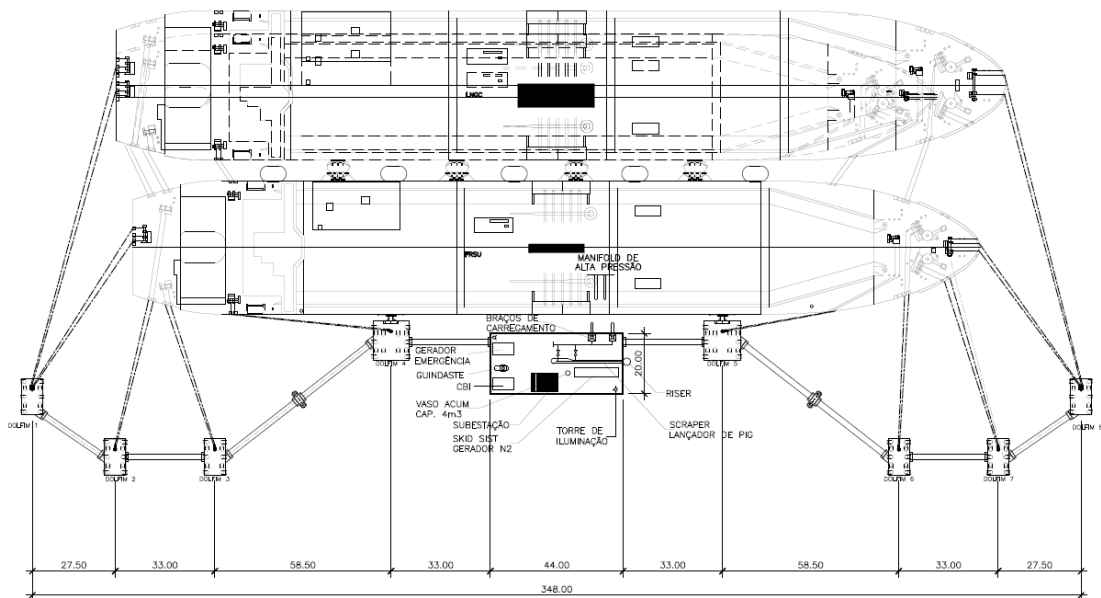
Planta do Pier de atracação (ship-to-ship). Fonte: LC Terminais (2025).
